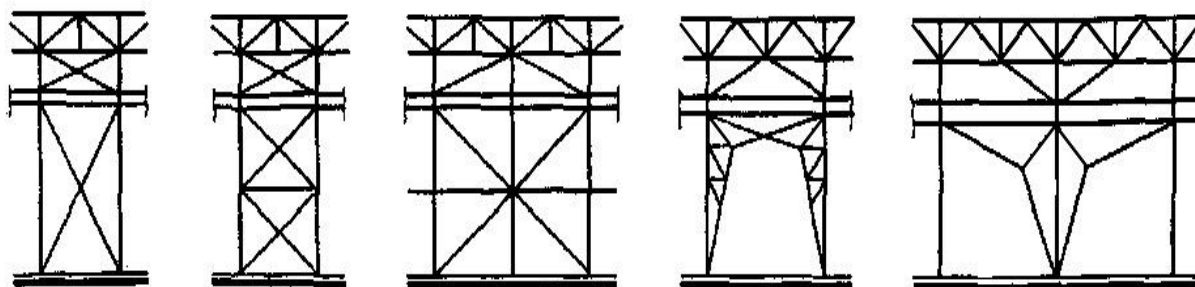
Стальные типы вертикальных связей между колоннами
